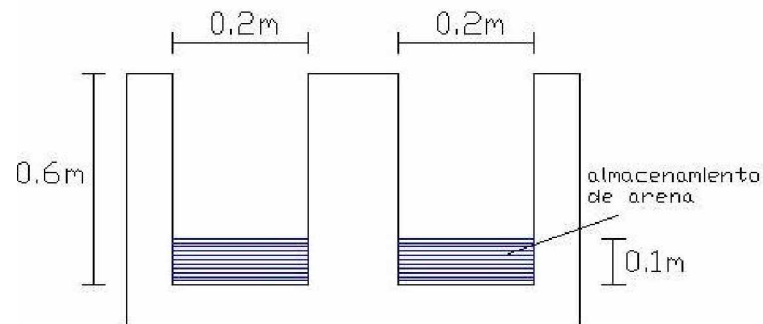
Sección transversal del desarenador para la Planta N°1
